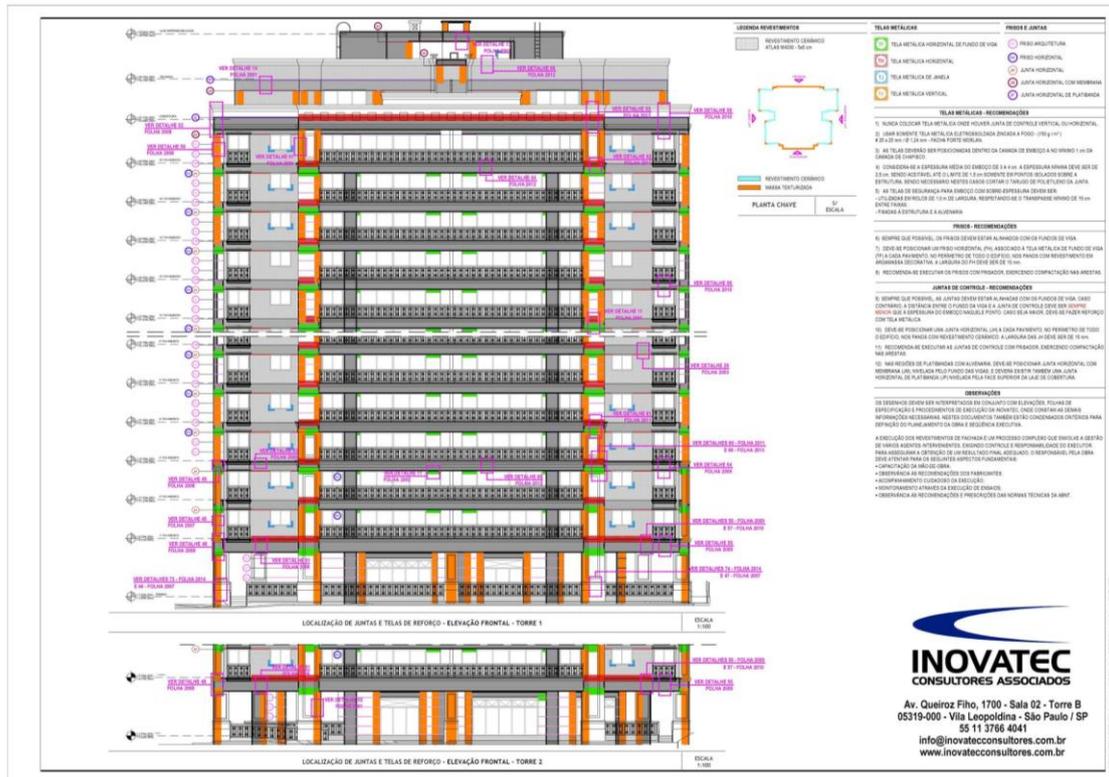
Projeto para produção de fachada: Elevação de telas e juntas de reforço (Fonte: Site da empresa Inovatec Consultores Associados – acesso em 21/03/2018)
